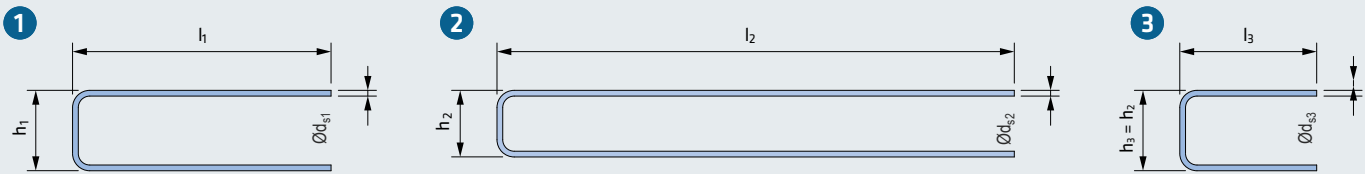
Арматування Schall-ISODORN HQW® на будівельному майданчику біля краю елемента
